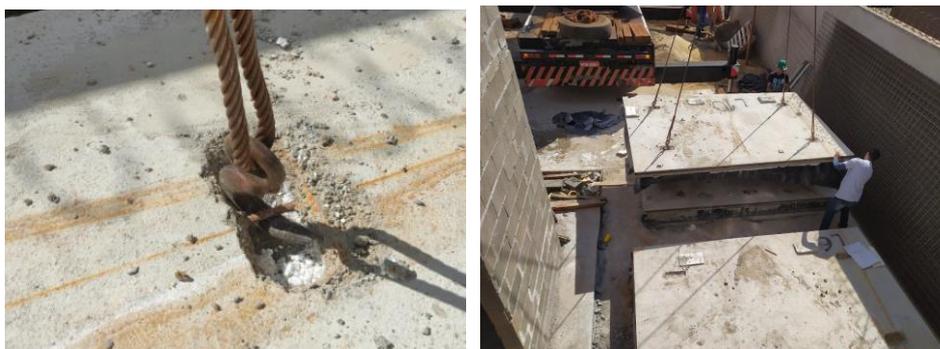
Pilhas de painéis de LMPM: 2º pavimento
